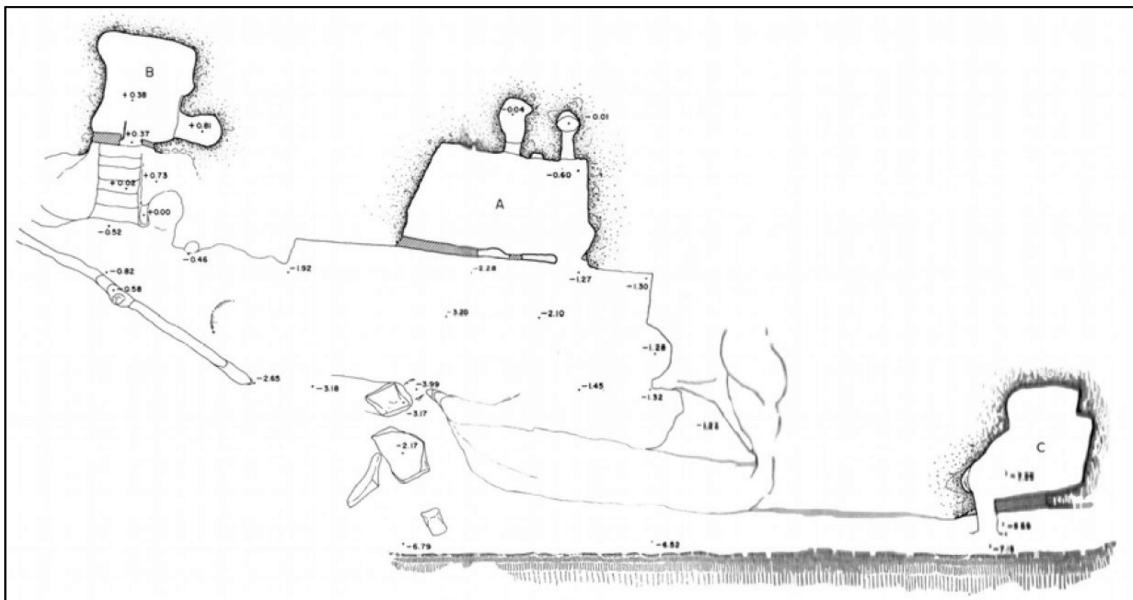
Vista en planta del eremitorio rupestre de Valdecanales realizada por Vañó Silvestre (1970).
